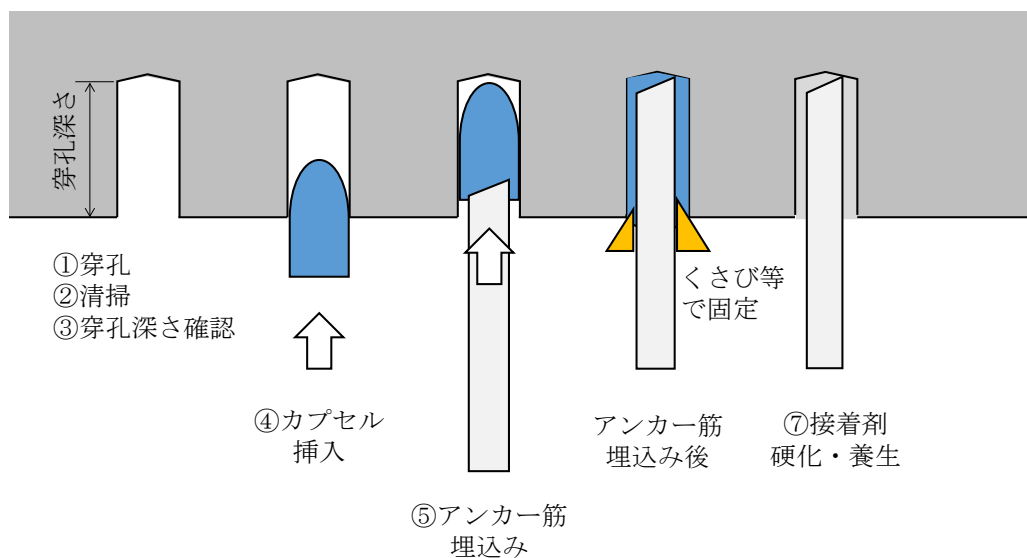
接着系あと施工アンカー（カプセル式）の施工手順の例
